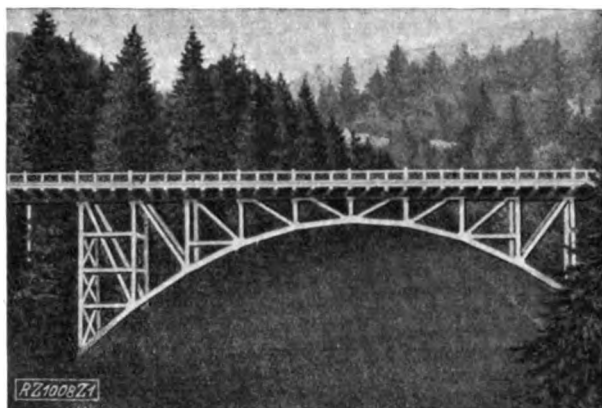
Eisenbeton-Bogenbrücke mit ungewöhnlicher Fachwerk-konstruktion.
